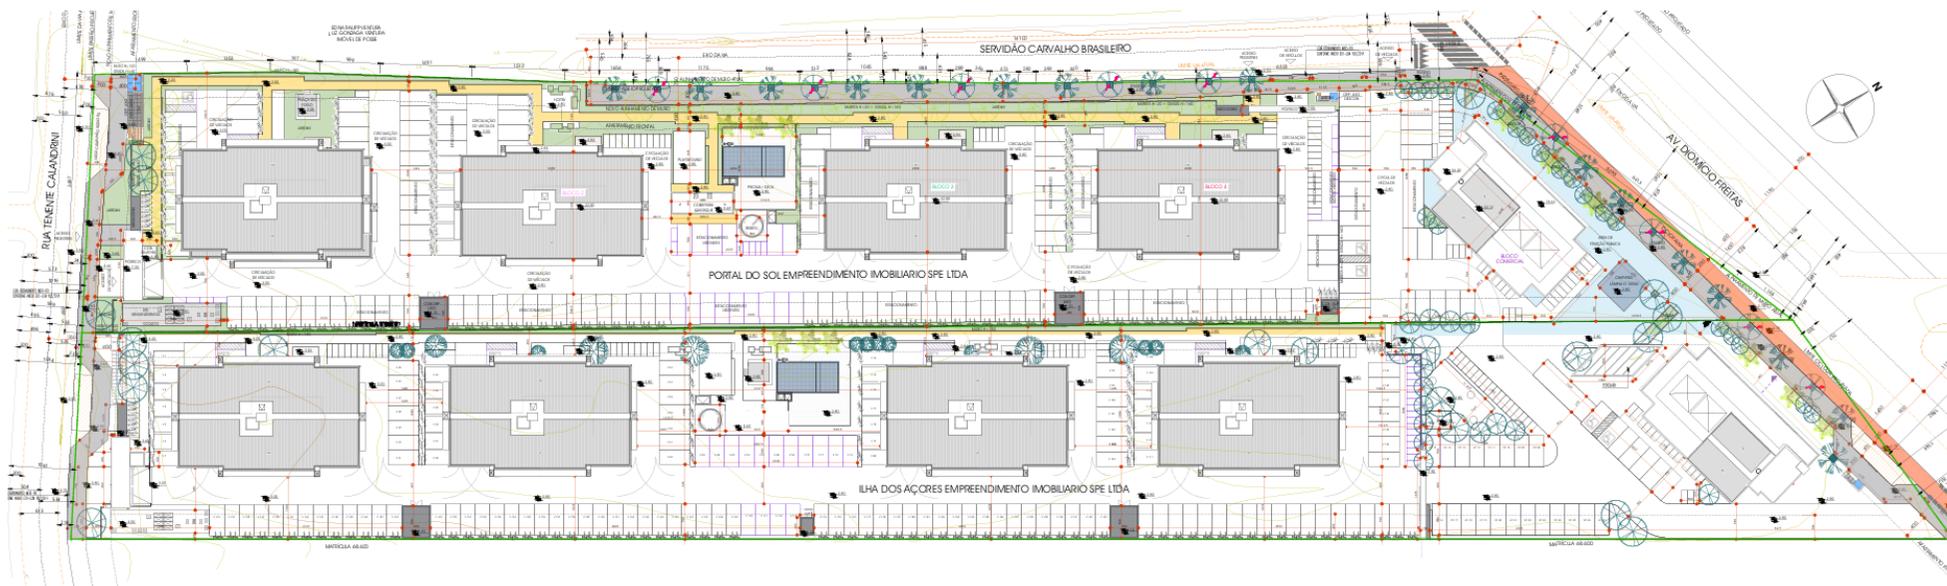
Implantação do empreendimento a ser construído, Ilha dos Açores e Portal do Sol, indicando a disposição dos blocos, áreas de estacionamento e manobra, de recreação e áreas verdes. Fonte: Otrebor, 2023.
